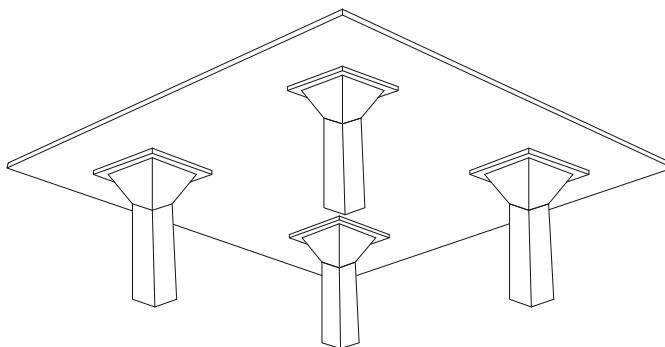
LOSAS PLANAS APOYADAS SOBRE COLUMNAS CON CAPITILES
